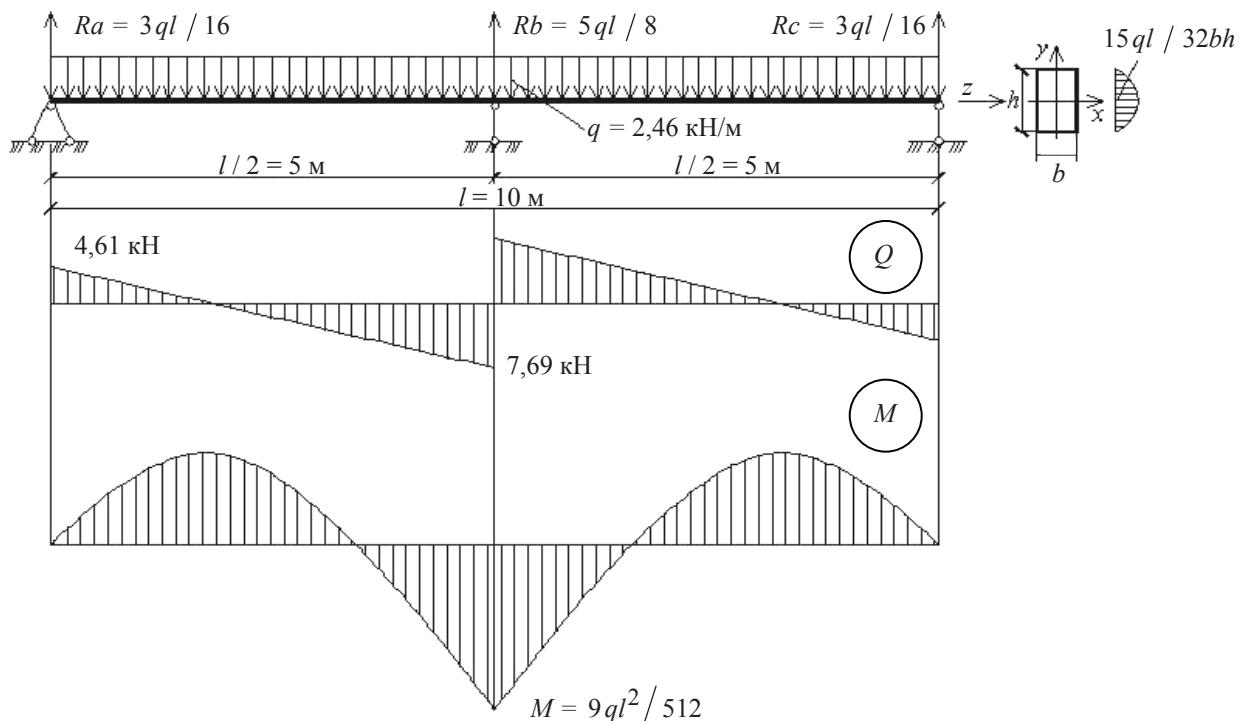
Расчетная схема балки перекрытия между первым и вторым этажами
